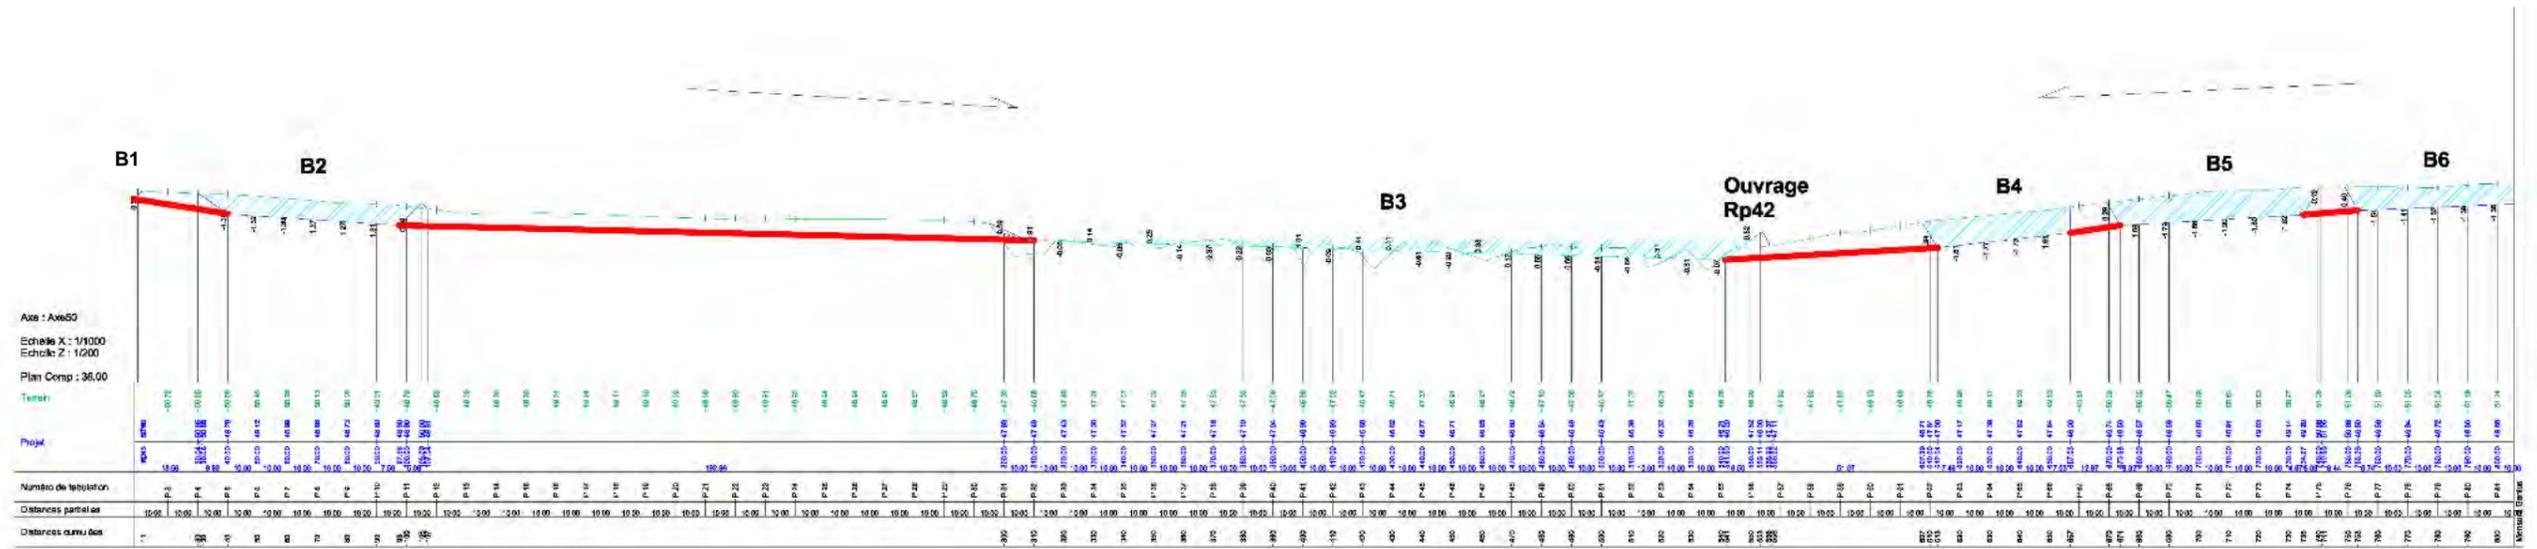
Coupe longitudinale des ouvrages de gestion des eaux pluviales du bassin versant Nord (source : TdM)
